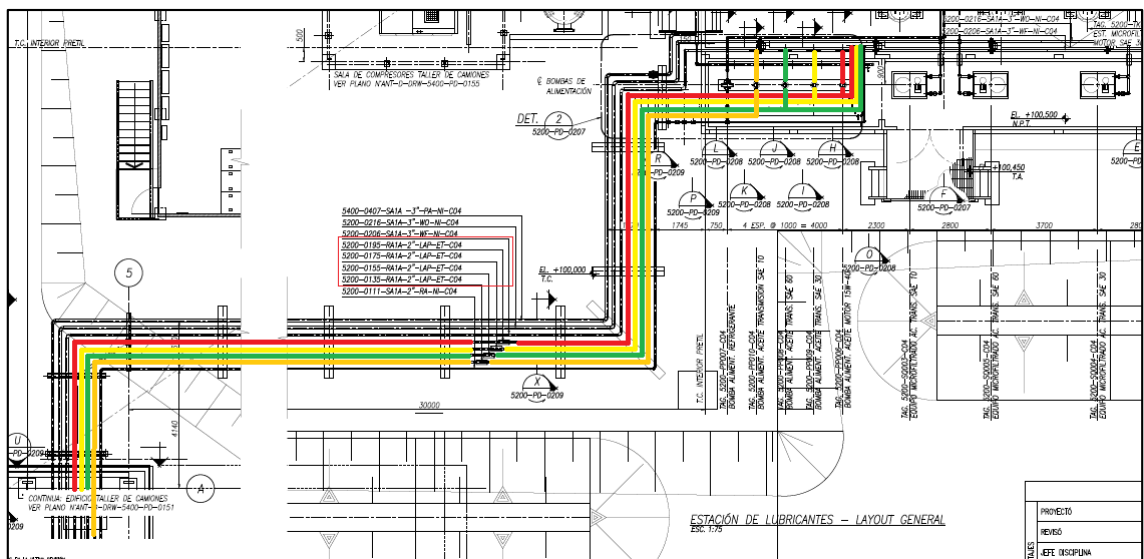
Plano de instalación con identificación de tuberías por color.
